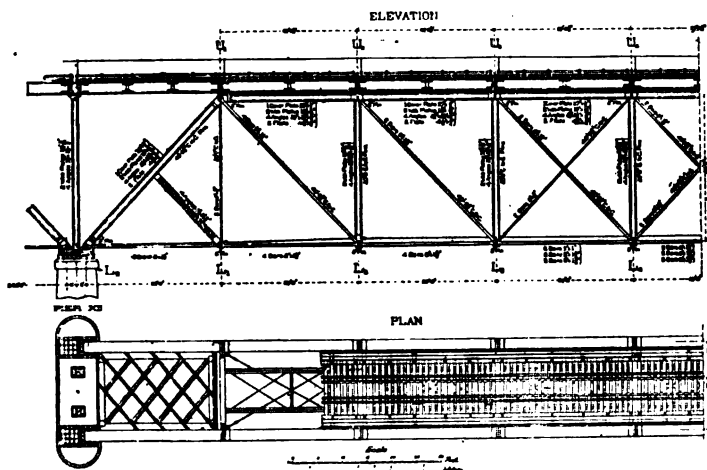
Dessins d'une demi-travée d'accès du pont de Cairo (Portée de 75^m,95).
